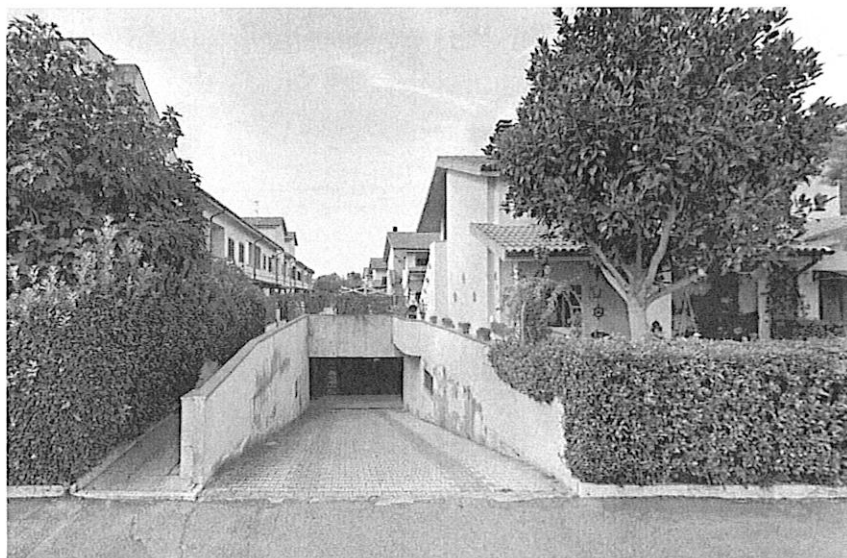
Vista rampa carrabile di accesso alle autorimesse al piano interrato
